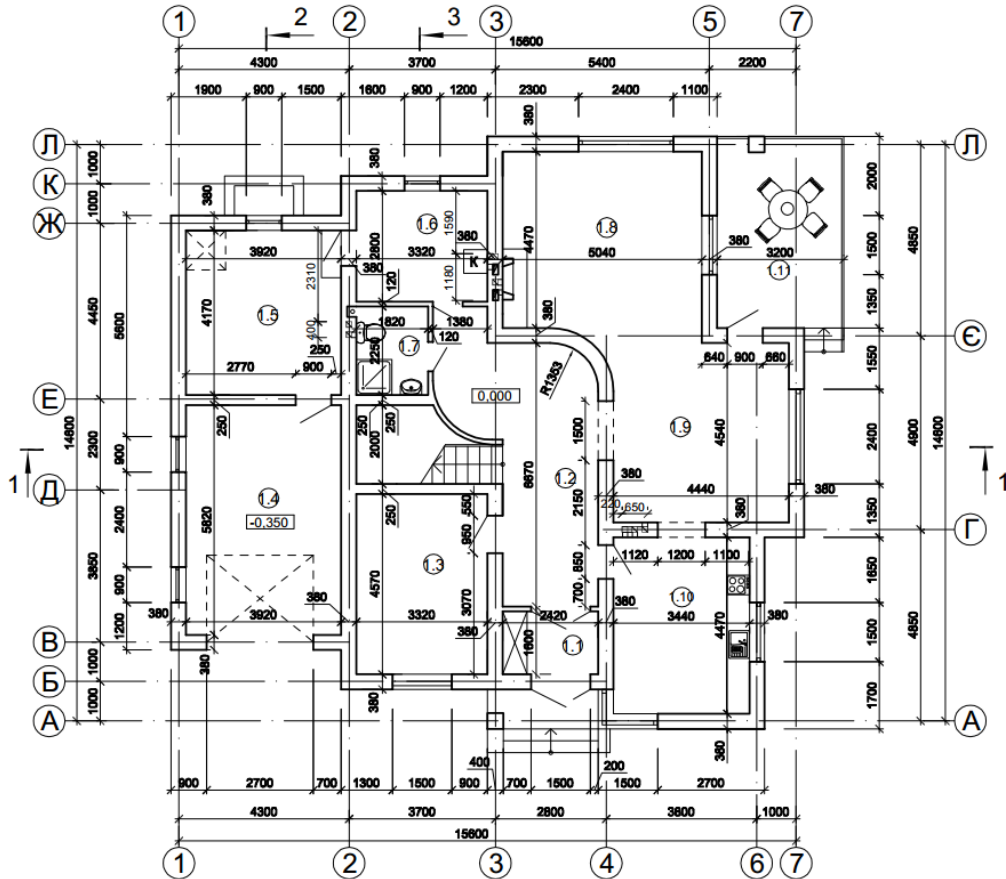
План будівлі житлового комплексу котеджного типу
